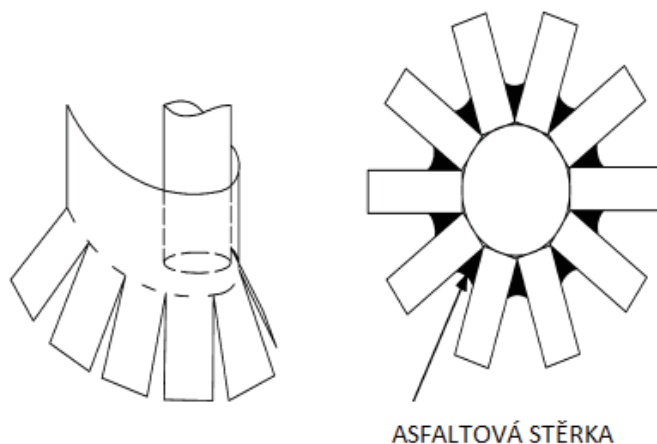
Spodní pás hydroizolace (zdroj: [6])
